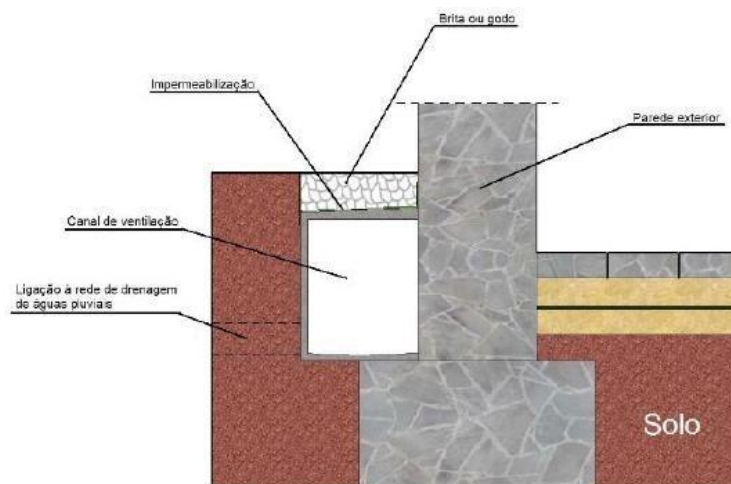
Corte construtivo do sistema de ventilação exterior [13]
